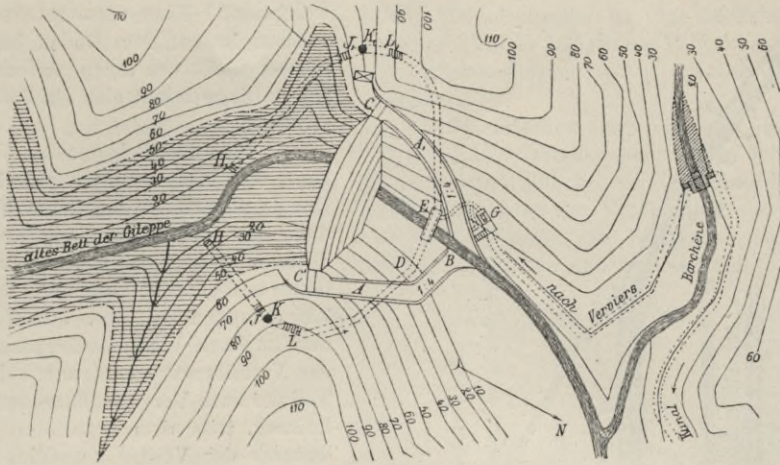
Lageplan der Talsperre an der Gileppe mit den Betriebseinrichtungen. Ungef. Maßstab 1:10000.
